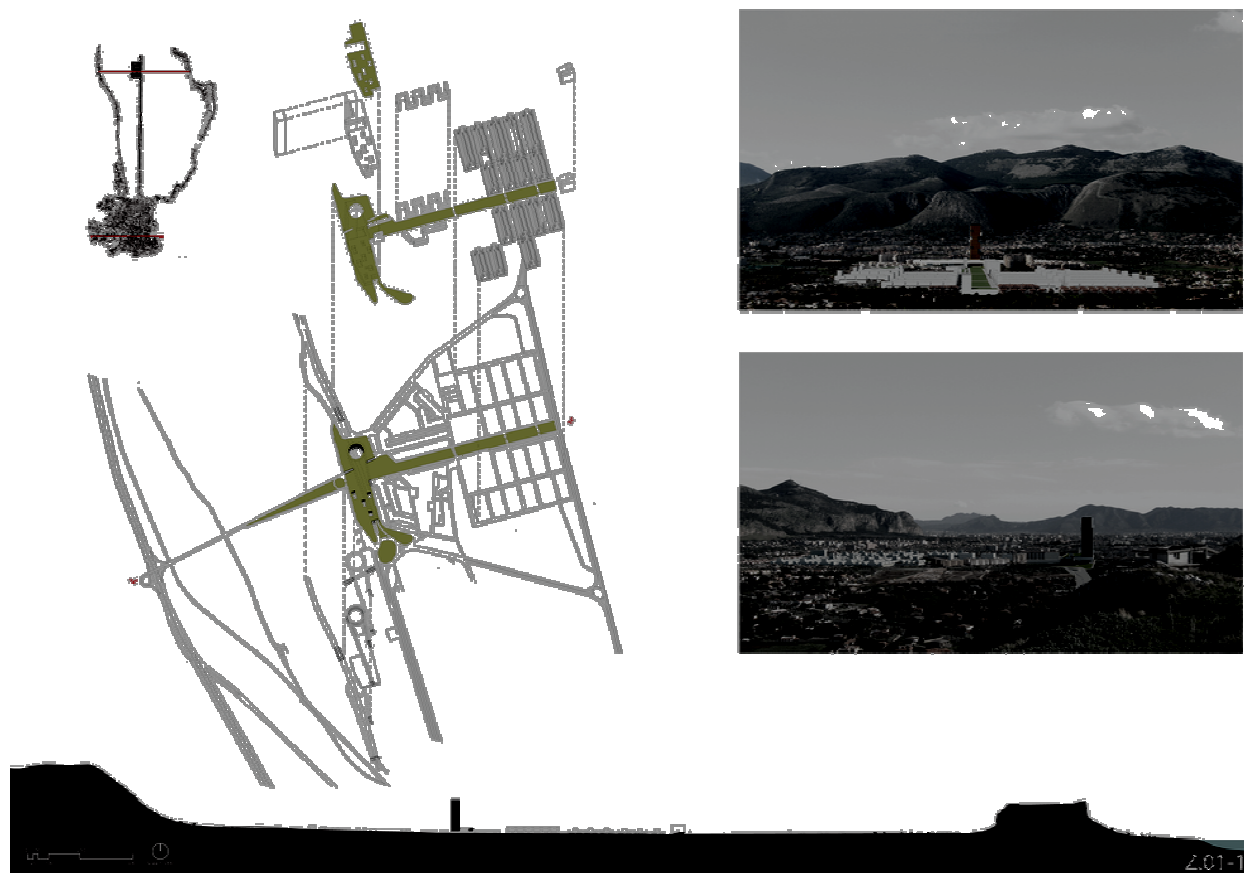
Il rapporto di proporzioni della torre con il contesto
